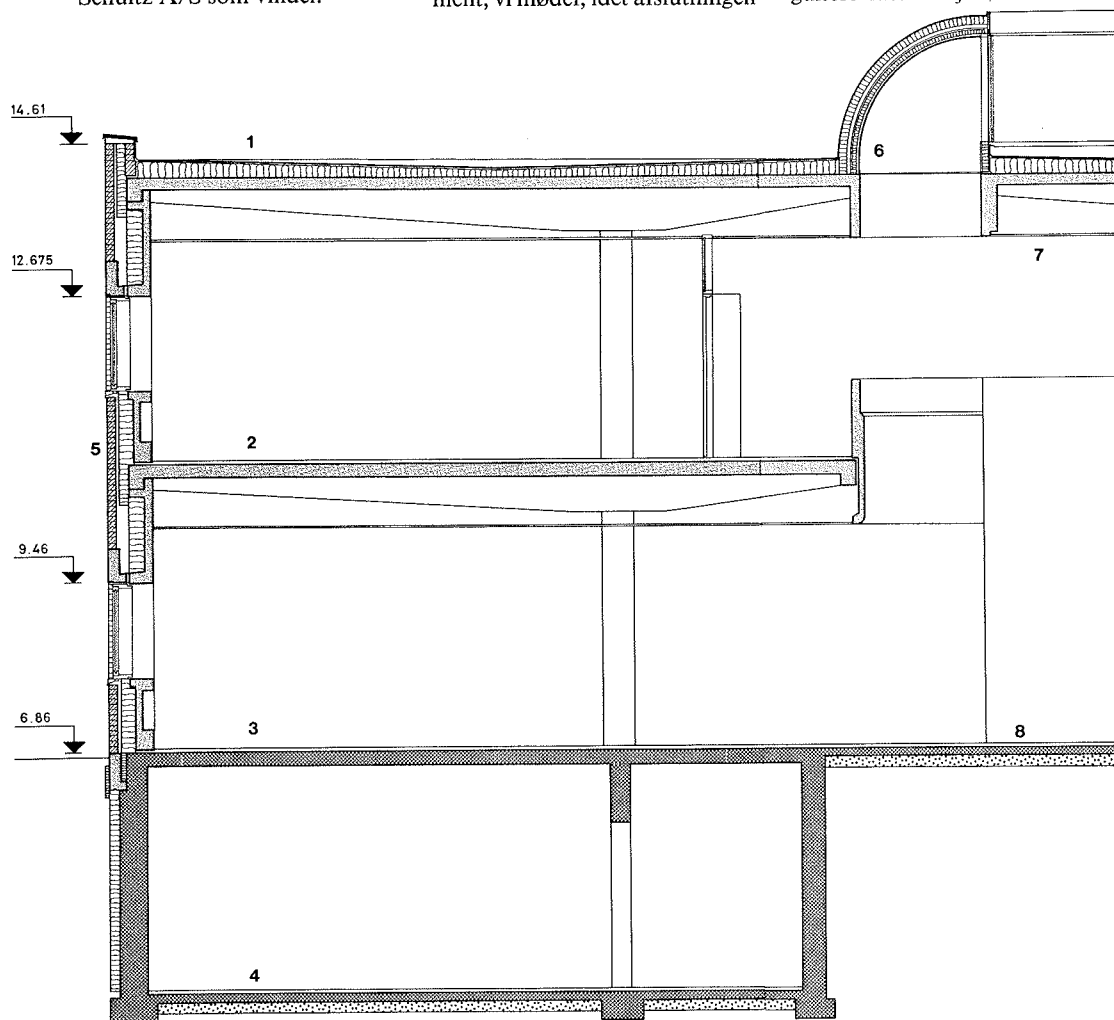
Lodret snit A-A, vedrørende placering se fig. 3. Mål 1:100. 1. Tagkonstruktion: trelags built-up med fald 1:40, kileskåret mineraluld, dampspærre, beton. 2. og 3. Etagedækskillelse: 4 mm linodur, 2 mm korkment, afretning, beton. 4. Kældergulv: støvbundet afretning, beton, leca. 5. Tung ydervæg: skalmur, mineraluld, beton-brystningselement. 6. Cirkulært ovenlys med lysindtag fra tagflade, konstruktionen går hele vejen rundt om den tunge betonplade over centralhallen. 7. Nedhængt loft. 8. Terrændæk i læsesal: 4 mm linodur, 2 mm korkment, afretning, beton, leca.
